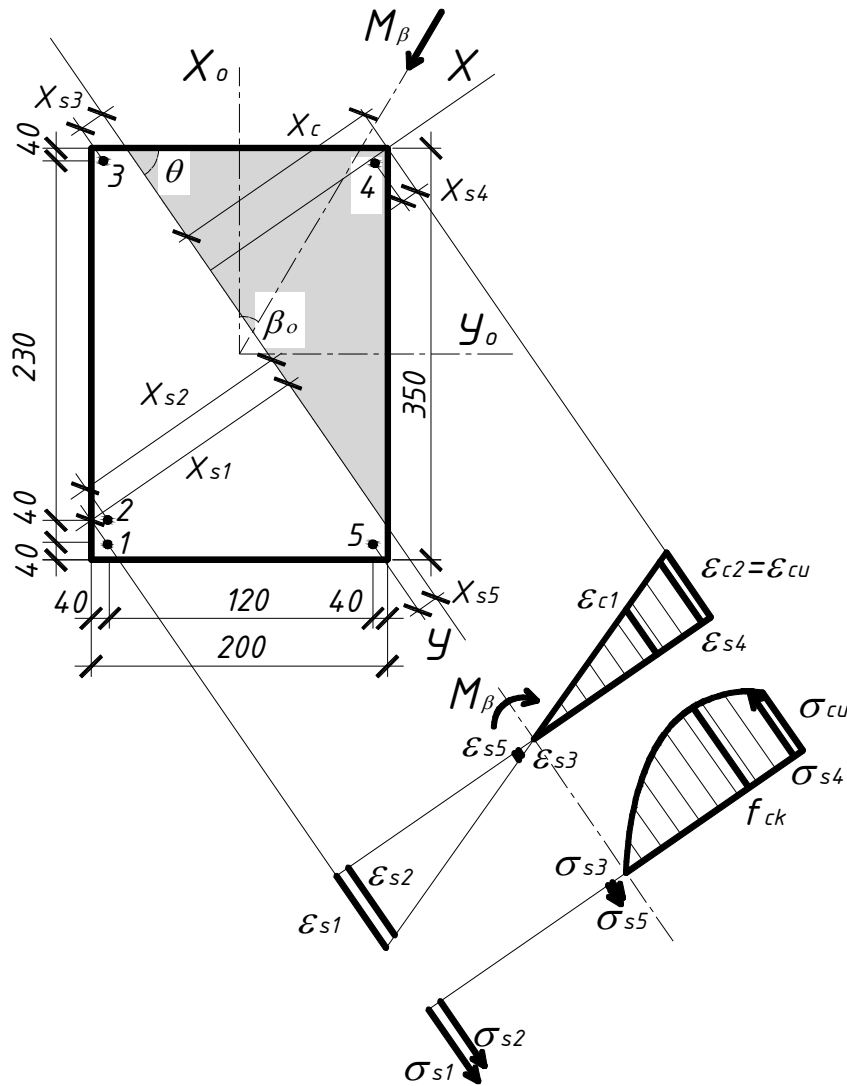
Розрахункова схема перерізу косозігнутої залізобетонної балки до прикладу Г.7
